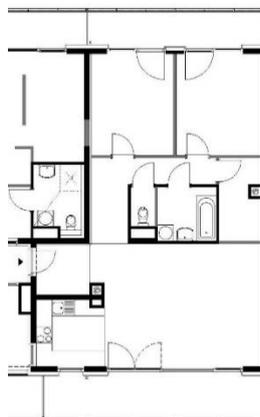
3-Zimmer- Wohnung mit eigenem Küchenbereich in Wohn-/Essbereich und Loggia zum Hof, Bauteil B Arch. C. Zwingl
